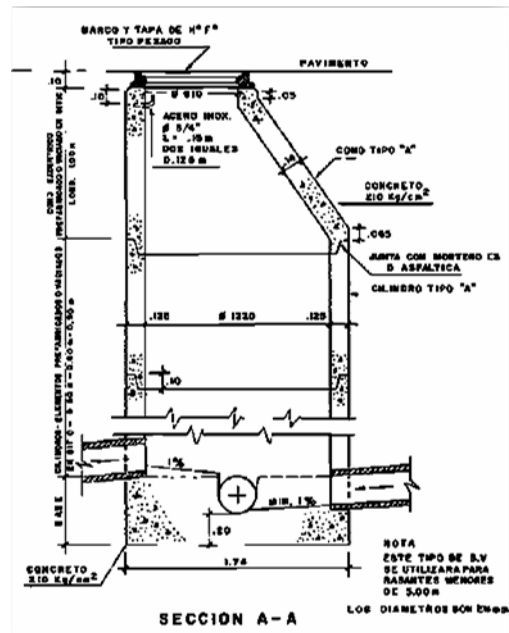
Planta Boca de Visita tipo Ia⁷
